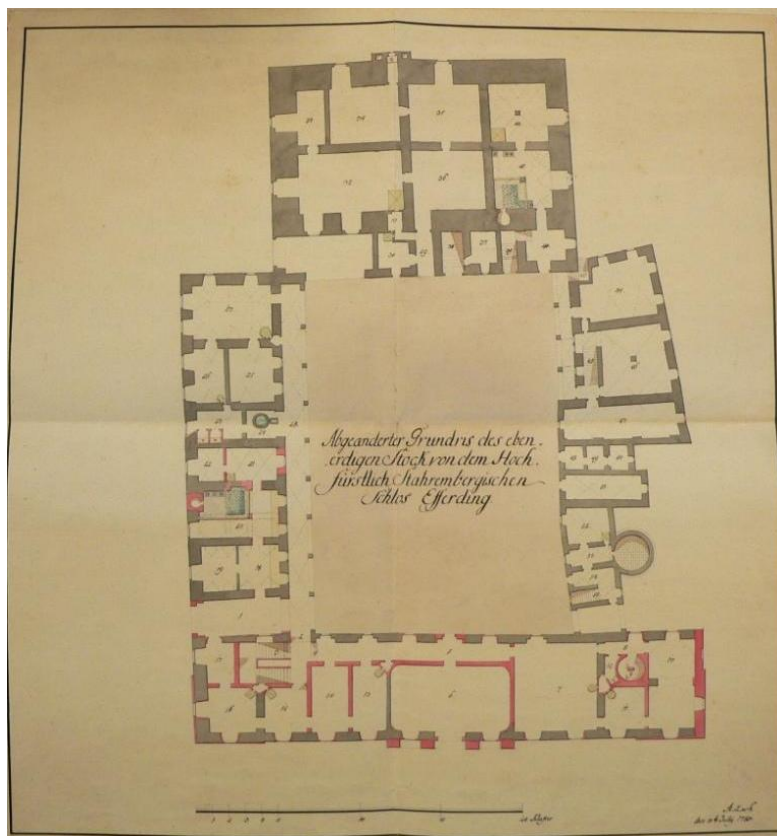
Schloss Eferding Grundriss Erdgeschoss, Andreas Zach 1785, OÖSLA.
